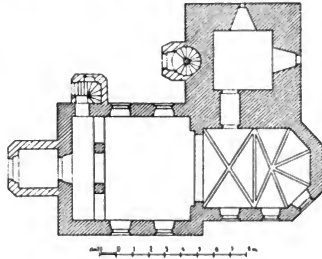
Wrbno. Grundriss der Kirche.
